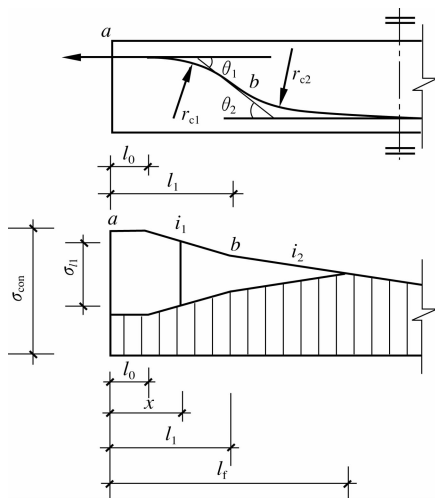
两条圆弧形曲线组成的预应力钢筋的预应力损失 σ_{II}
